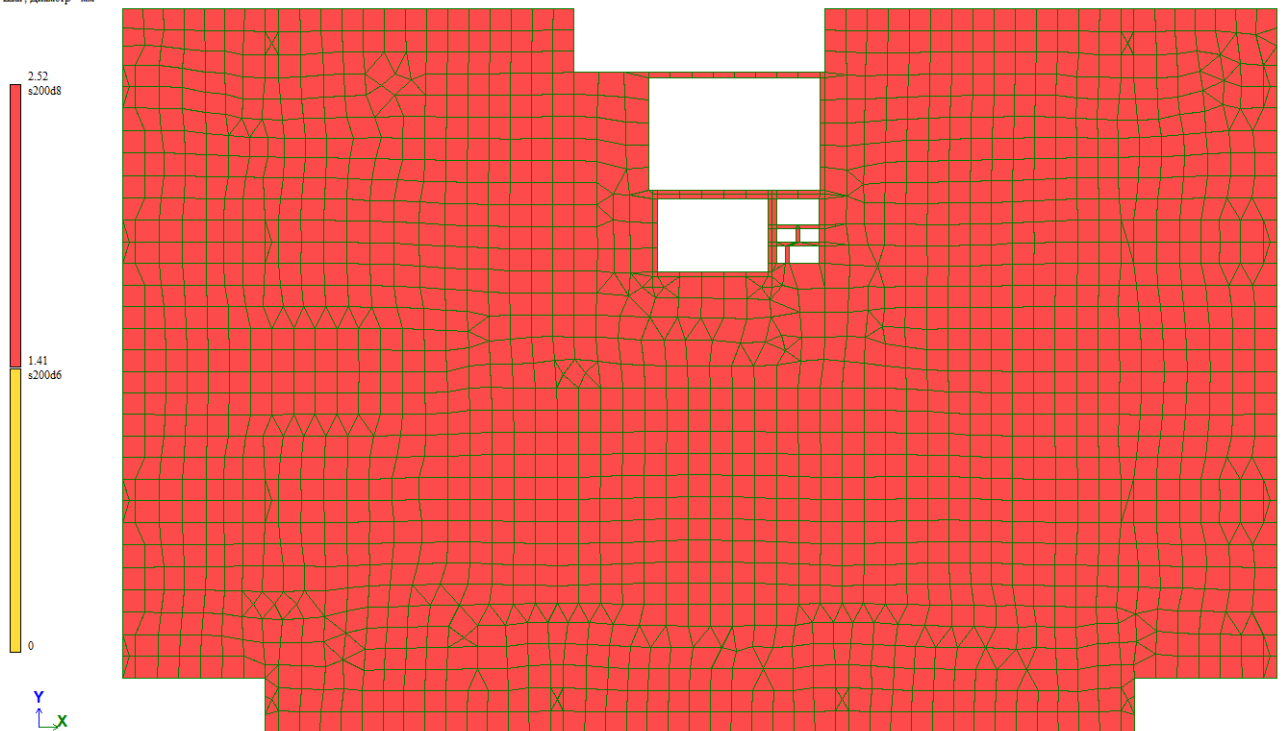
Нижнє армування плити першого поверху вздовж осі Y
